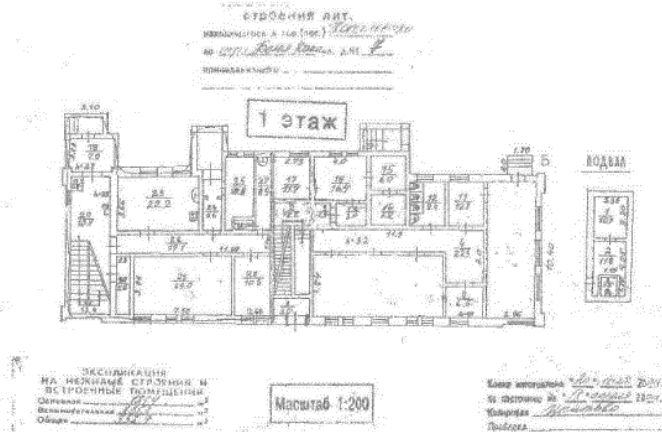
План 1-го этажа двухэтажного обследуемого жилого дома
